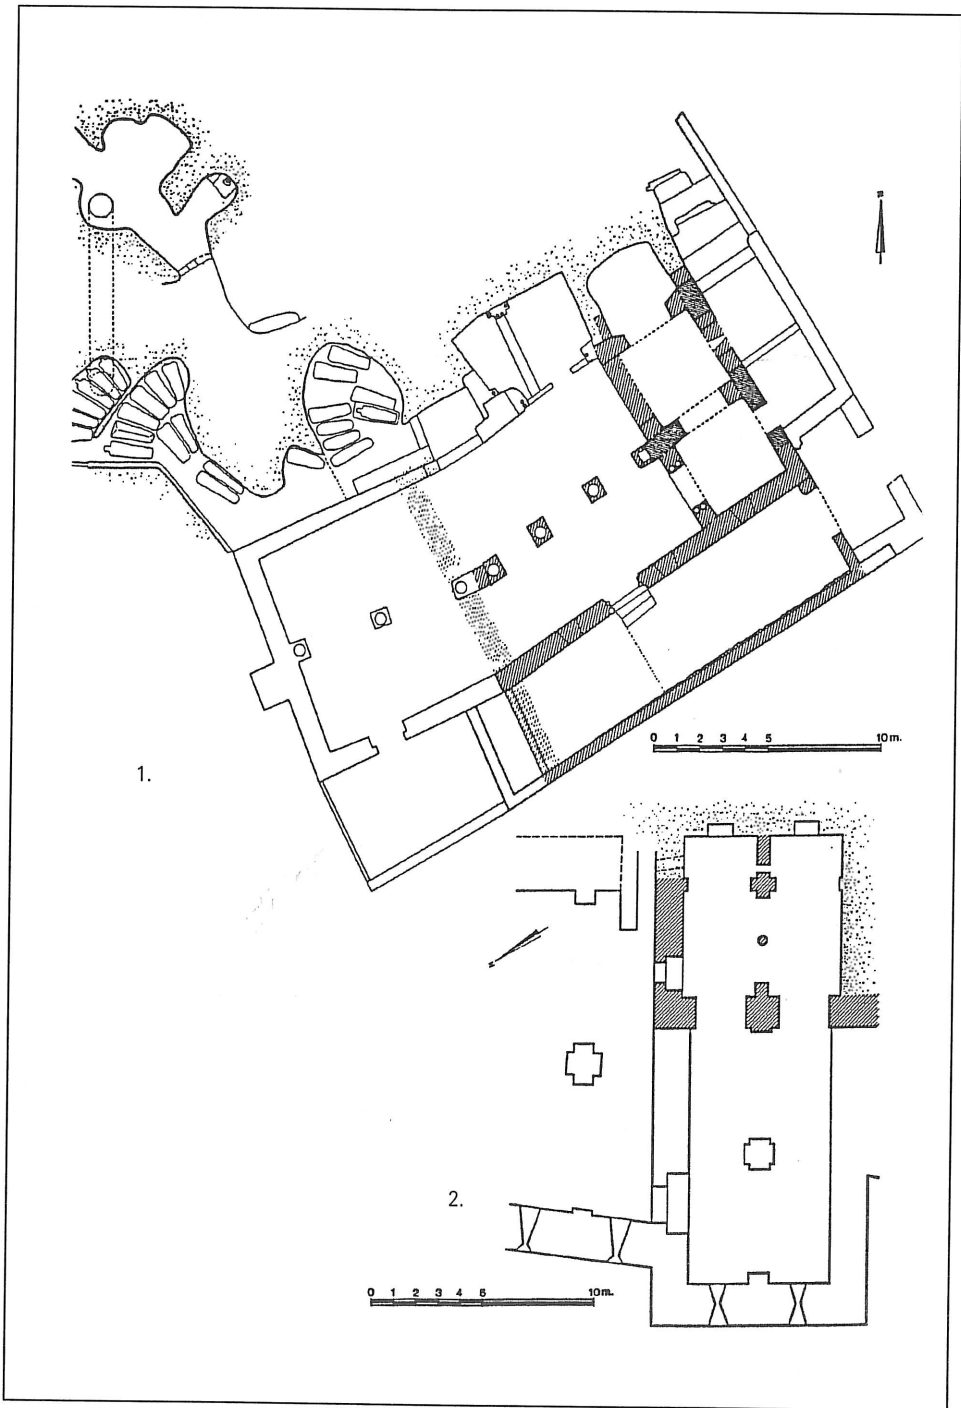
1. San Millán de la Cogolla de Suso (La Rioja). Planta (según: Puertas Tricas). 2. San Juan de la Peña (Huesca). Planta (según: Iñiguez Almech)
